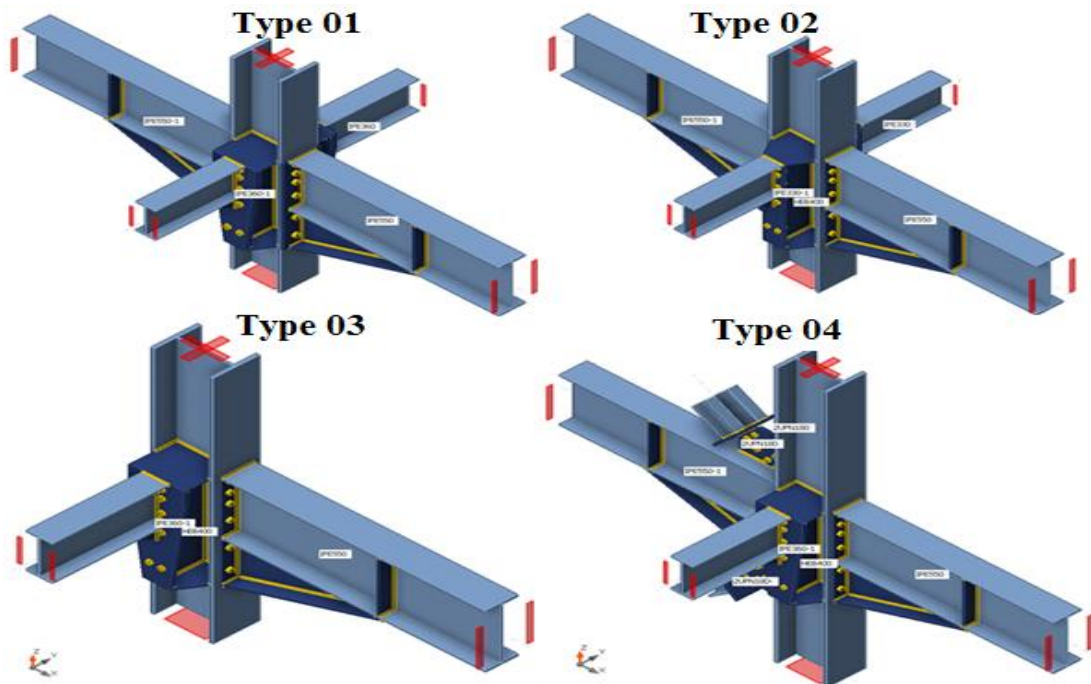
Vue 3D de l'assemblage des poteaux poutres.
